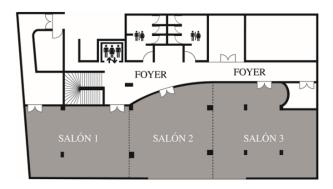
Planimetría del Salón 1, Salón 2, Salón 3
